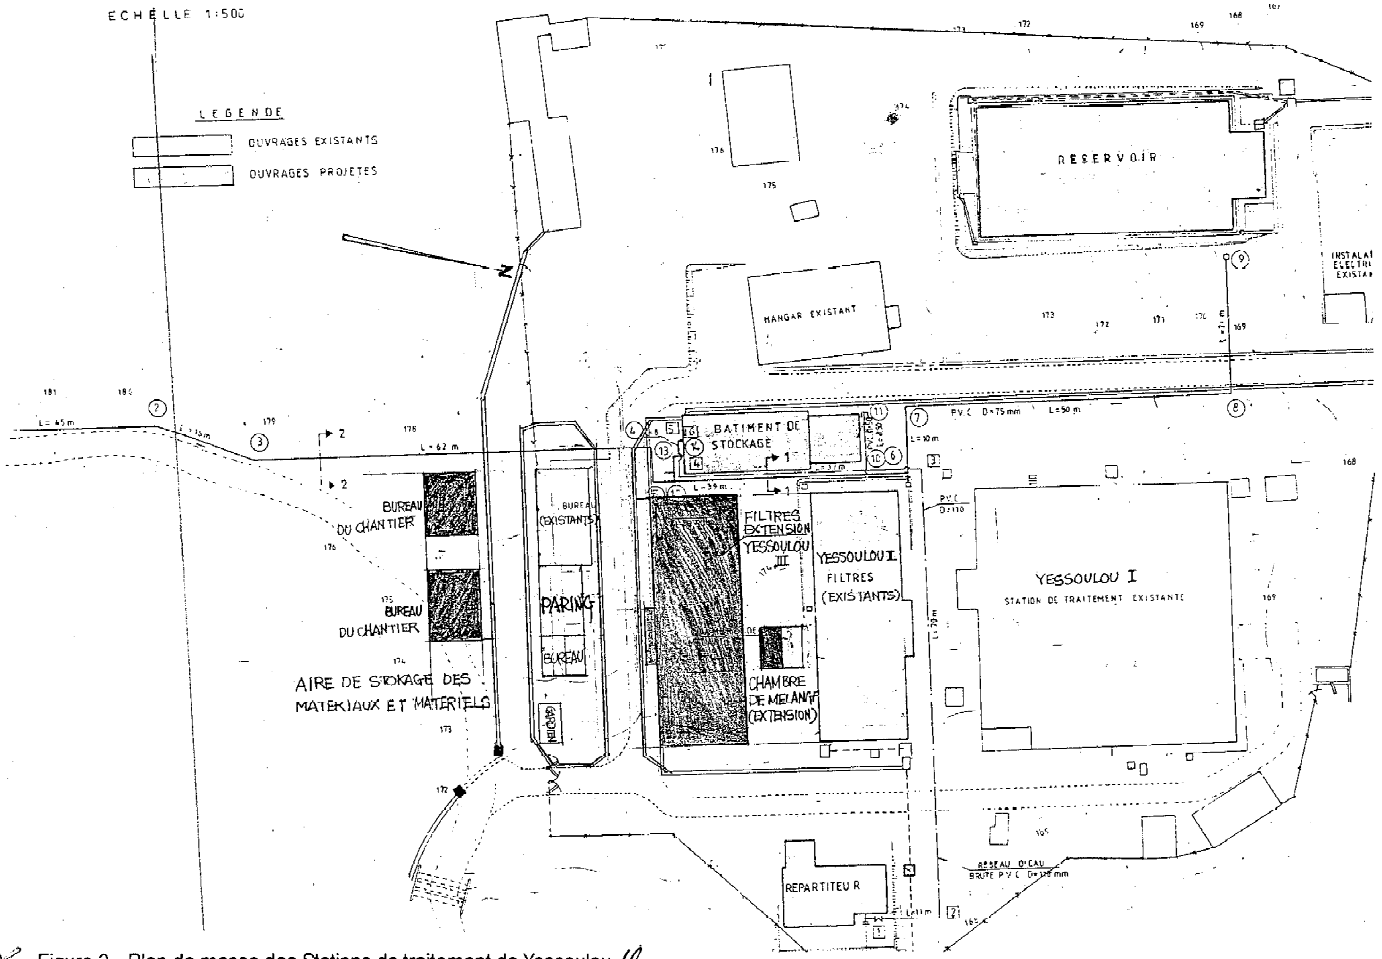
Plan de masse des Stations de traitement de Yessoulou
